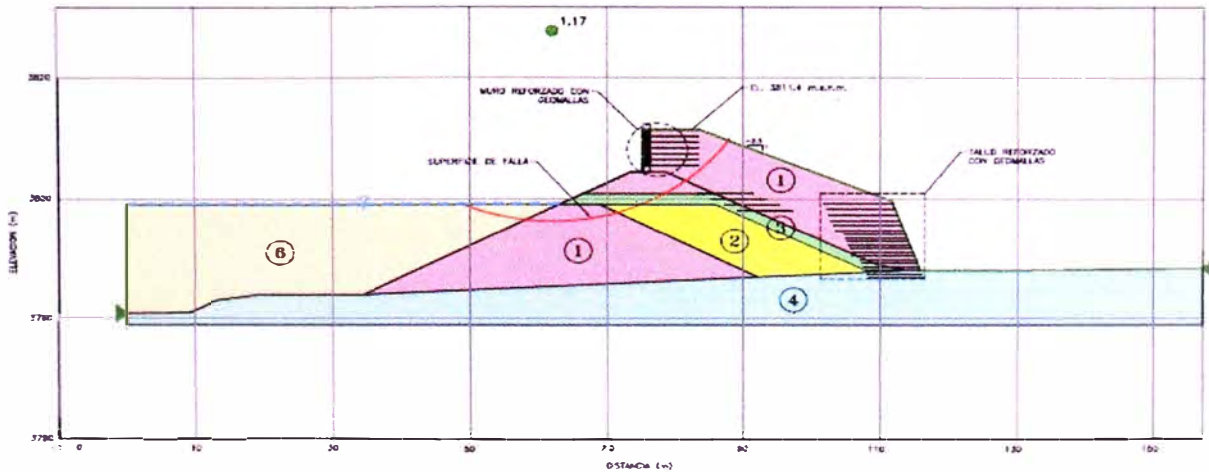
Muro de talud reforzado – Análisis Pseudo-estático – Sección B
